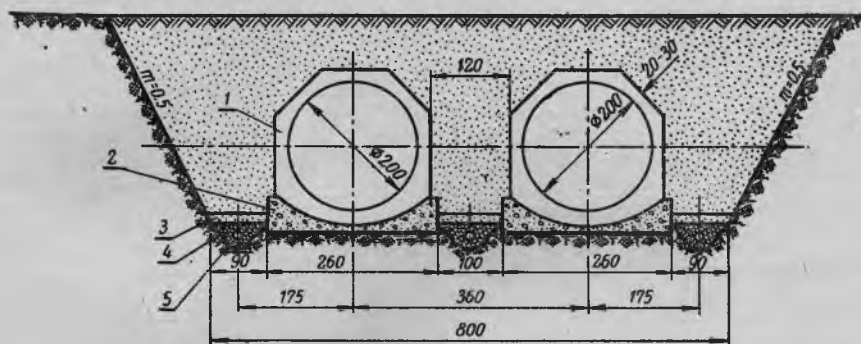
Конструкция и укладка железобетонного монолитного напорного трубопровода:
